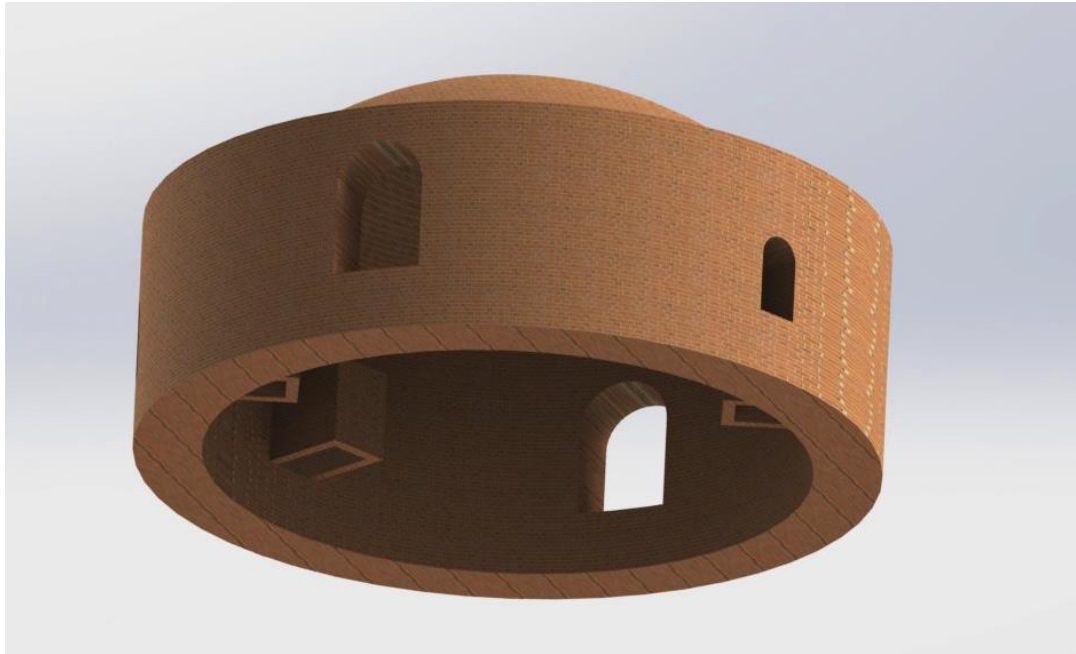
Vista isométrico inferior del modelo CAD 3D del Horno ladrillero.
